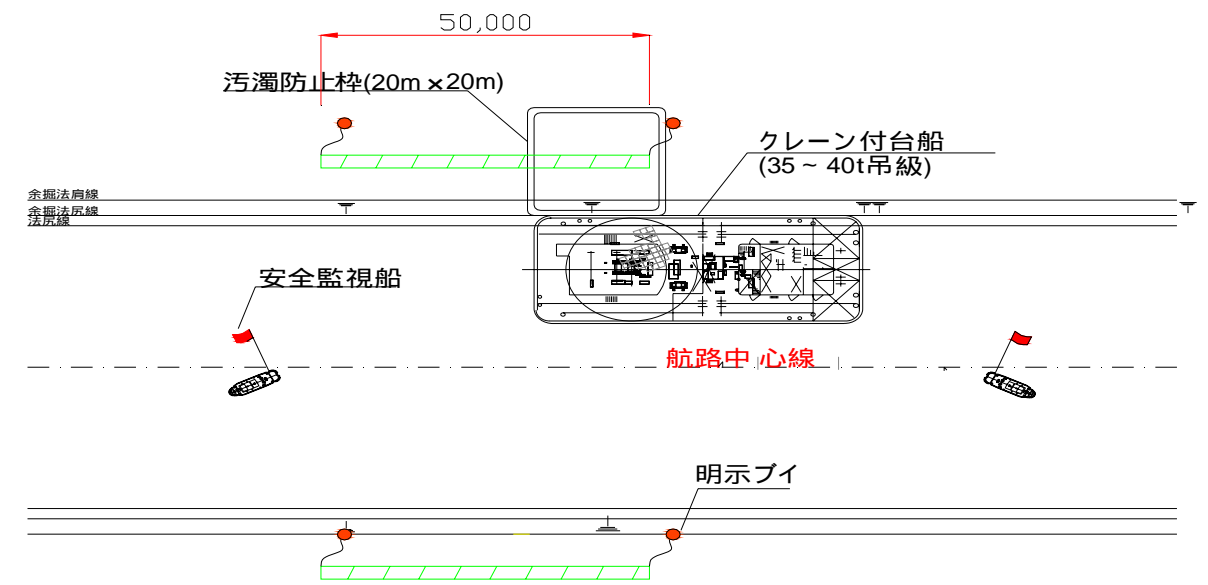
埋没防止対策の平面図（海域：小浜航路上）
